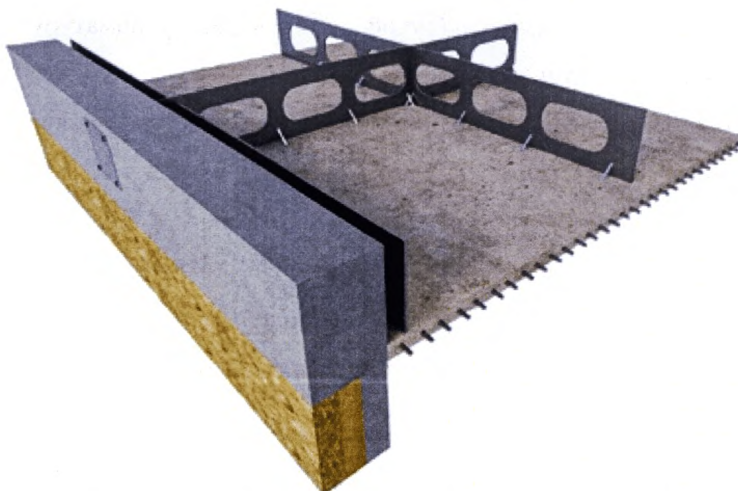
Плита и верхние балки стен-оболочек
